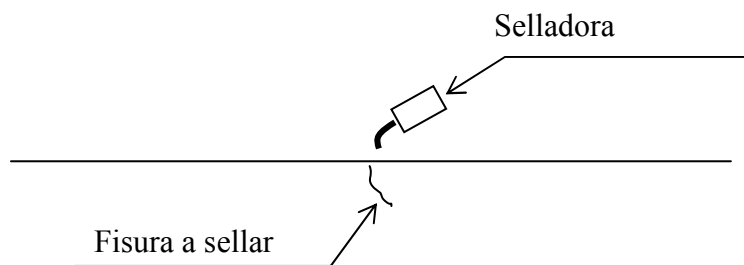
Aplicación de poliflex para el sello de grietas en el pavimento. (Elaborado por los autores).
